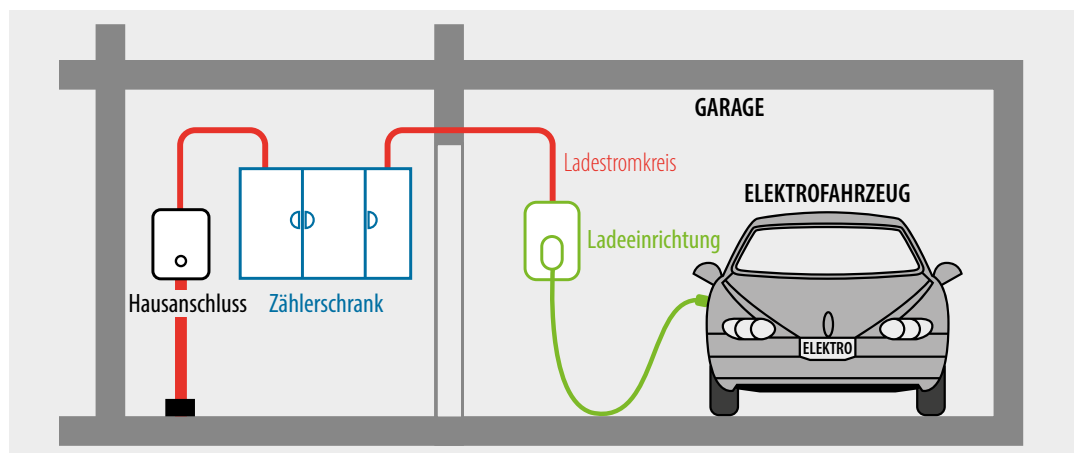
Prinzipieller Aufbau der Elektroinstallation einer Ladeeinrichtung
